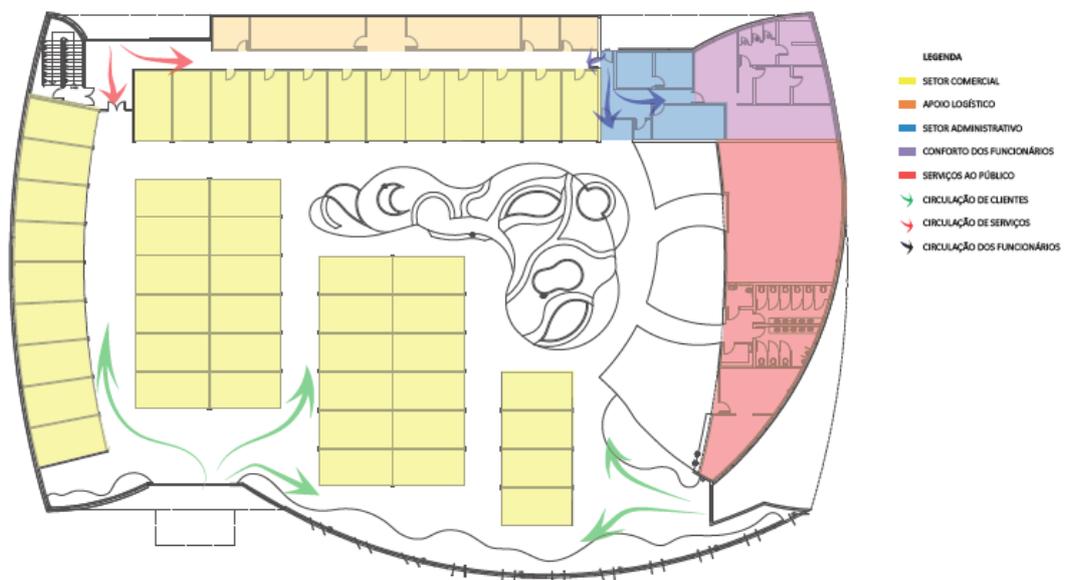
Planta de Setorização com Fluxos. Fonte: Acervo do autor.
